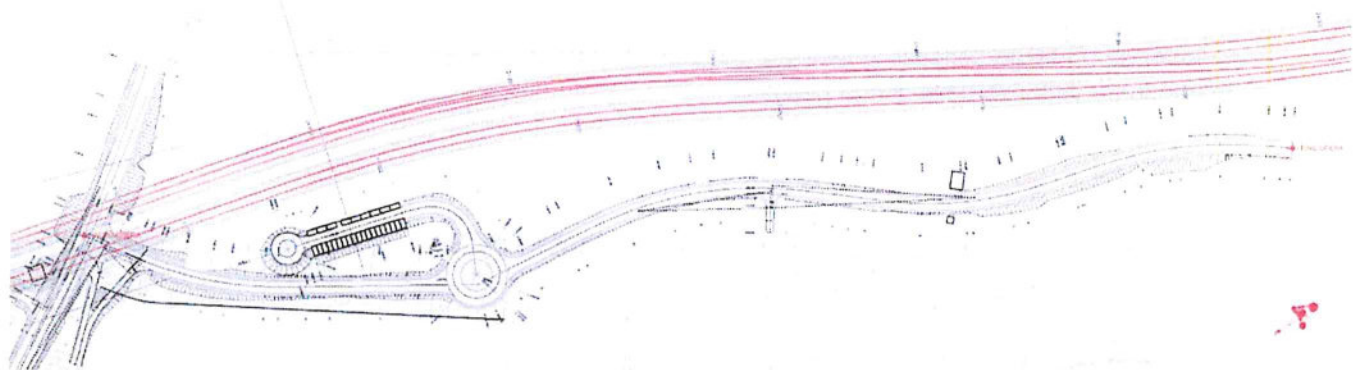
NV05 – Stralcio planimetrico su rilievo di Via L.Fava
